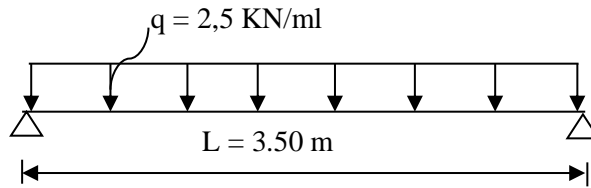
Schéma statique d'une travée de la poutrelle
